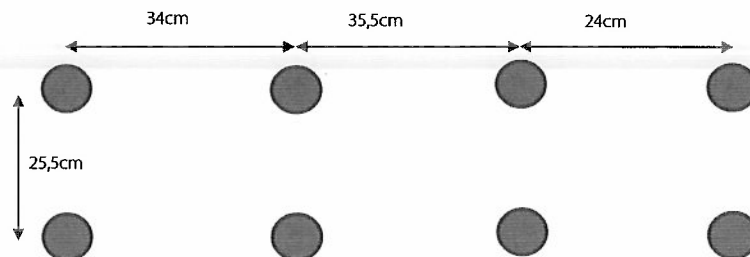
Esquema en planta zona de maniobras y andén túnel
